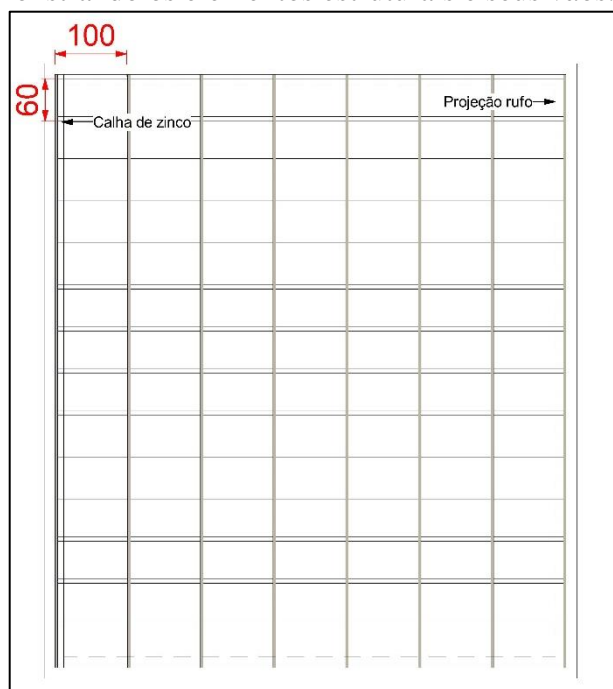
Planta de cobertura embutida com telha fibrocimento
